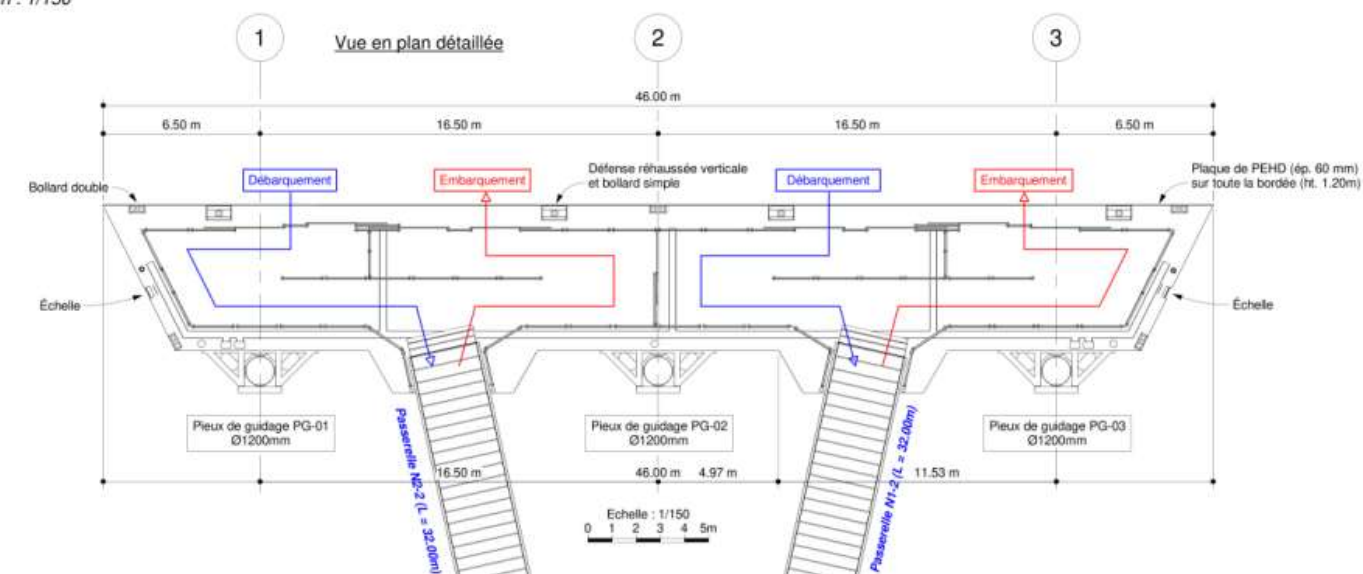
Plan du ponton d'amarrage (SCE, décembre 2023)
